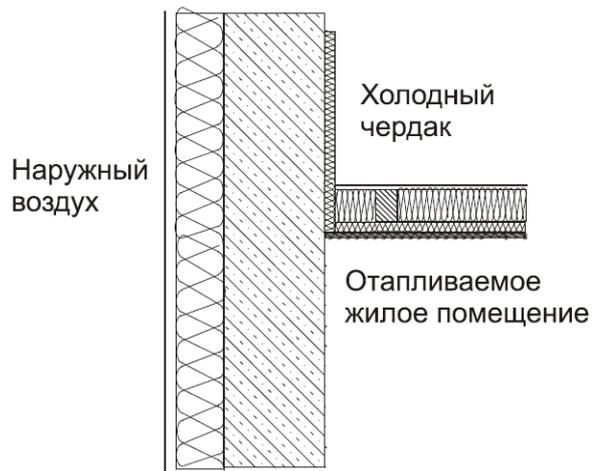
Схема утепления стыка внешней стены с чердачным перекрытием [2]
